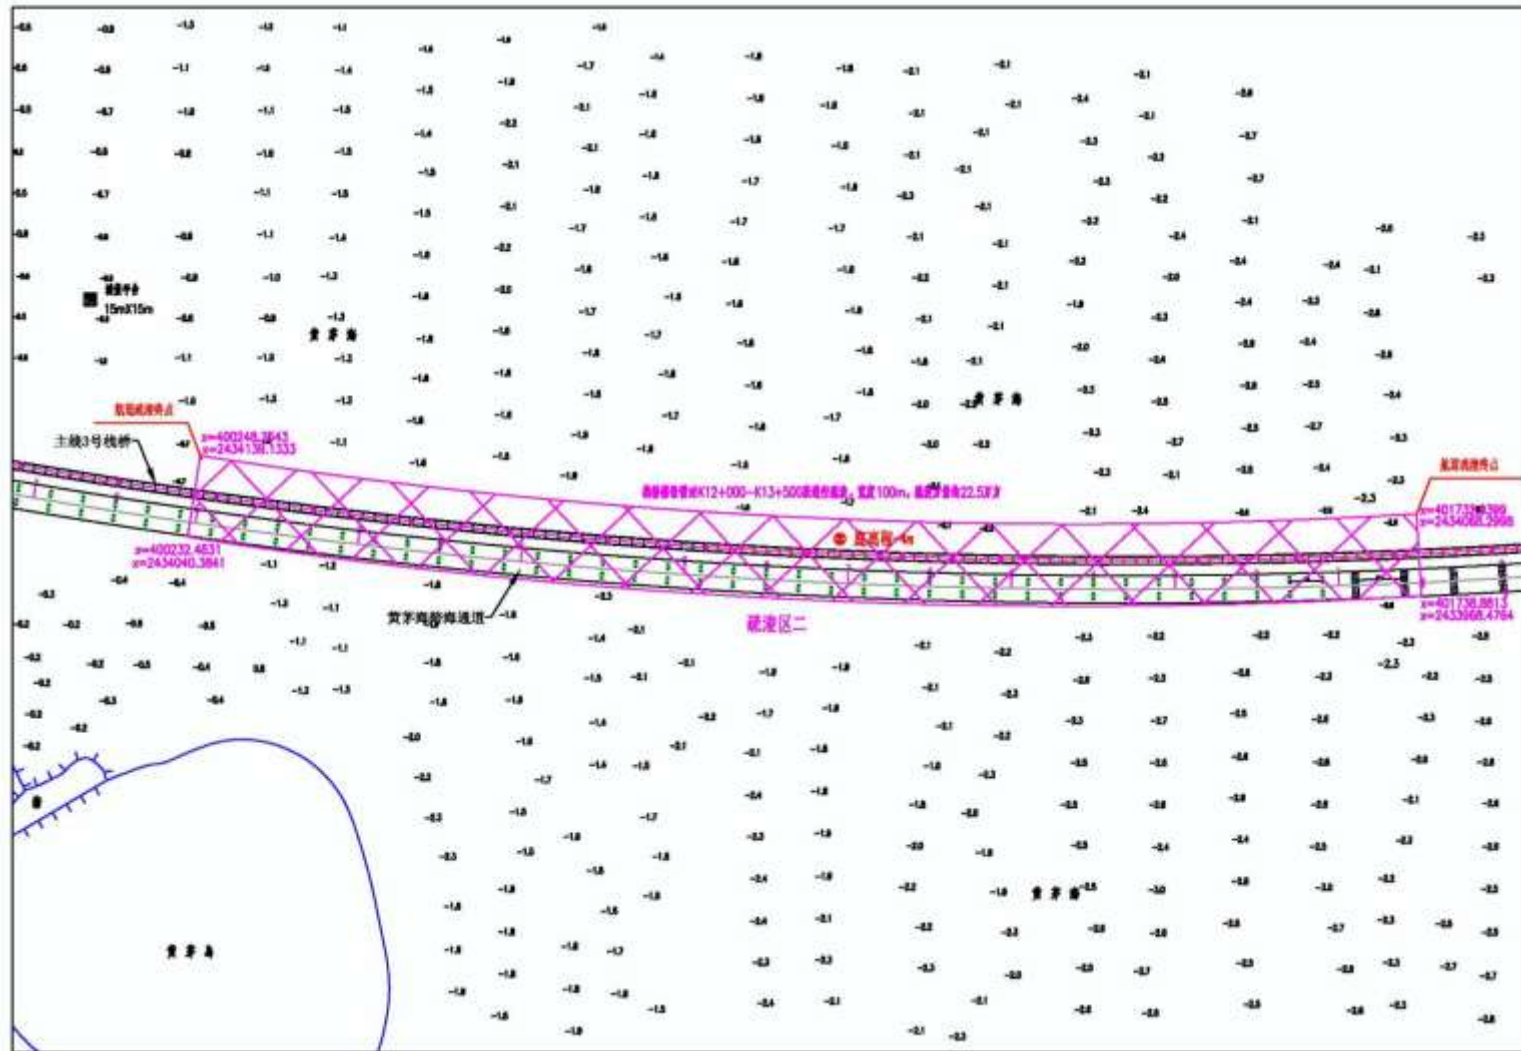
疏浚区二平面图（尺寸单位：m）
